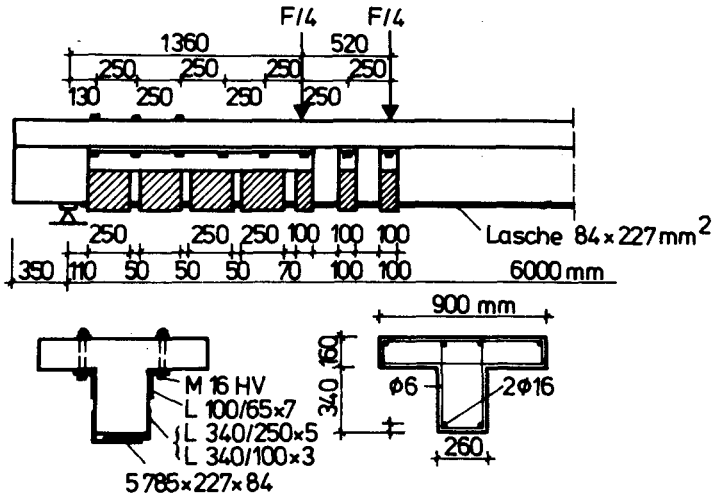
Plattenbalken mit angeklebter Zug- und Schubbewehrung nach /33/
